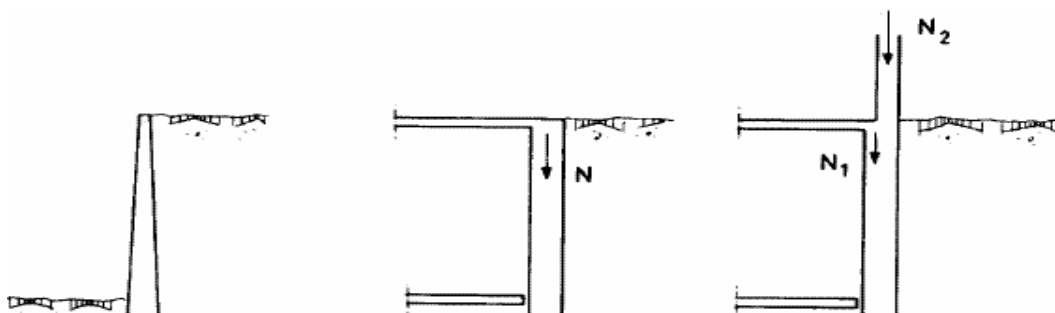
, Tipos de esfuerzo en una zapata, Estructuras de cimentación
